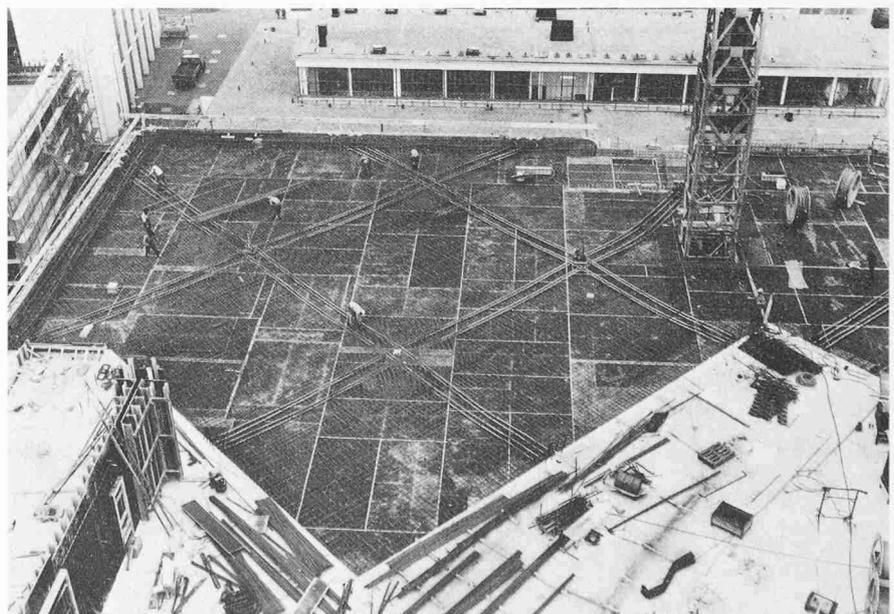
Flachdecke des Verwaltungsgebäudes im Bauzustand
